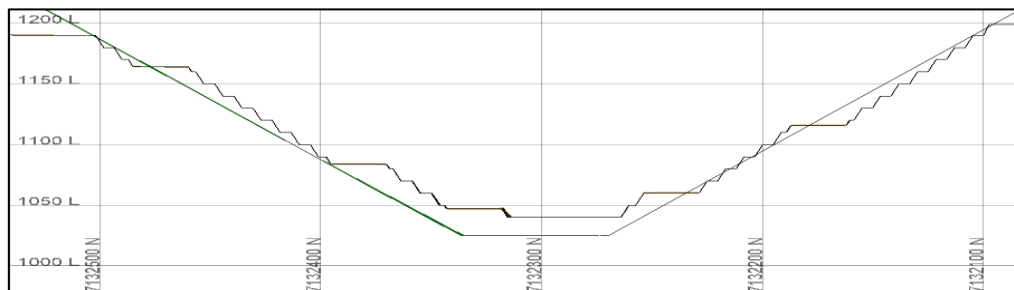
LGMM1Y Fase 1 - Vista en sección - Corte secundario N-S E394100
